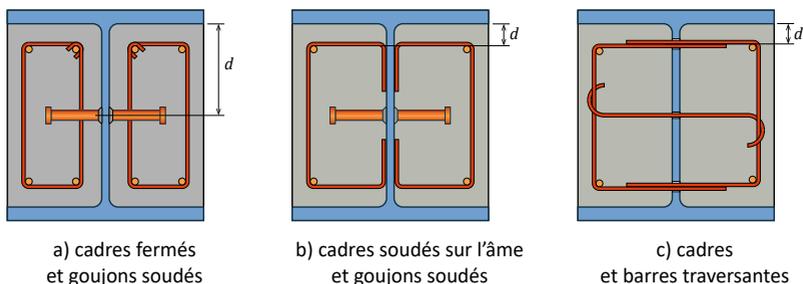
Procédés de fixation du béton d'enrobage sur l'âme du profilé
